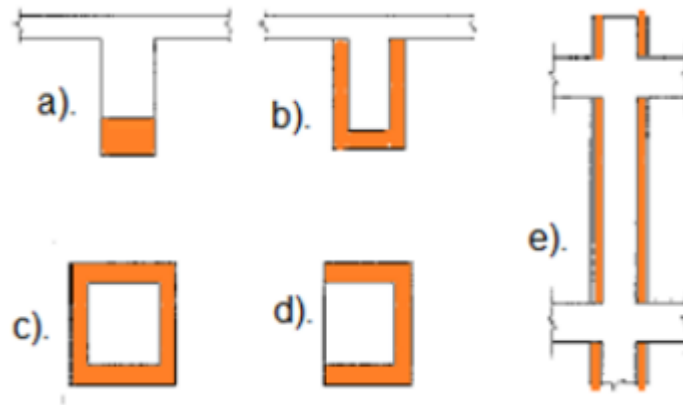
Forma de aumento de sección para los elementos estructurales
